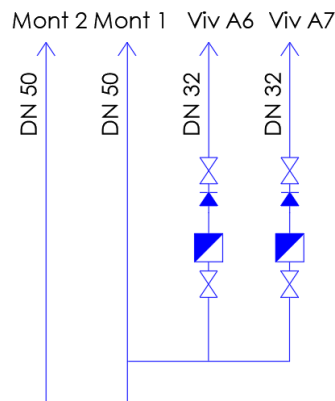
Detalle de las tuberías en el rellano de una planta tipo A en la escalera 1
